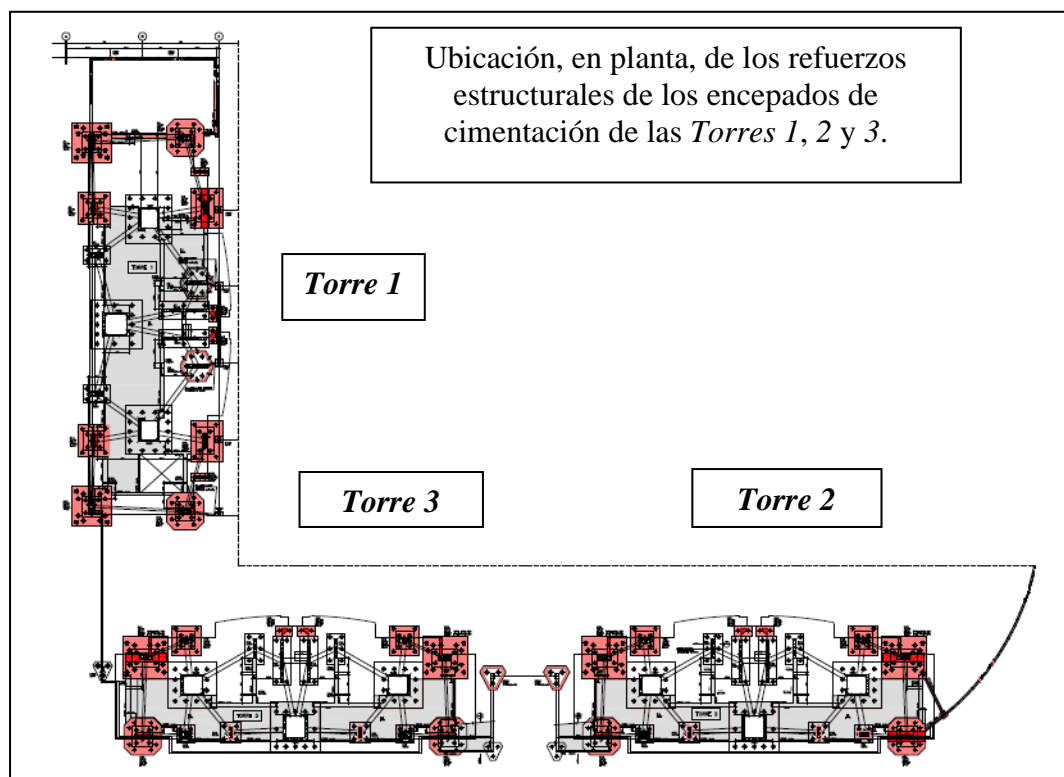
Detalle en planta, de la ubicación de los refuerzos estructurales de los encepados de cimentación de las torres residenciales.
